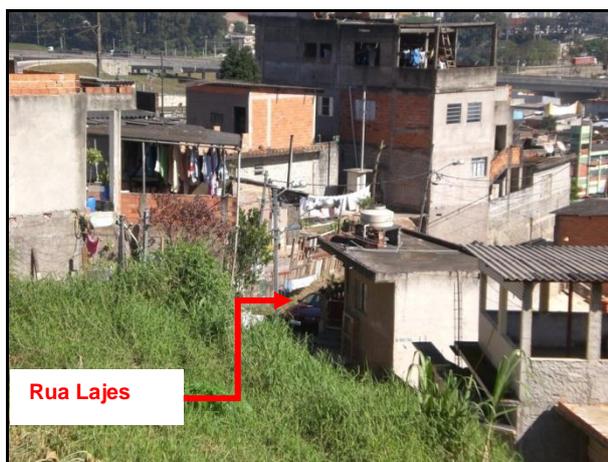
Encosta junto à Rua Guarujá e Rua Lajes
